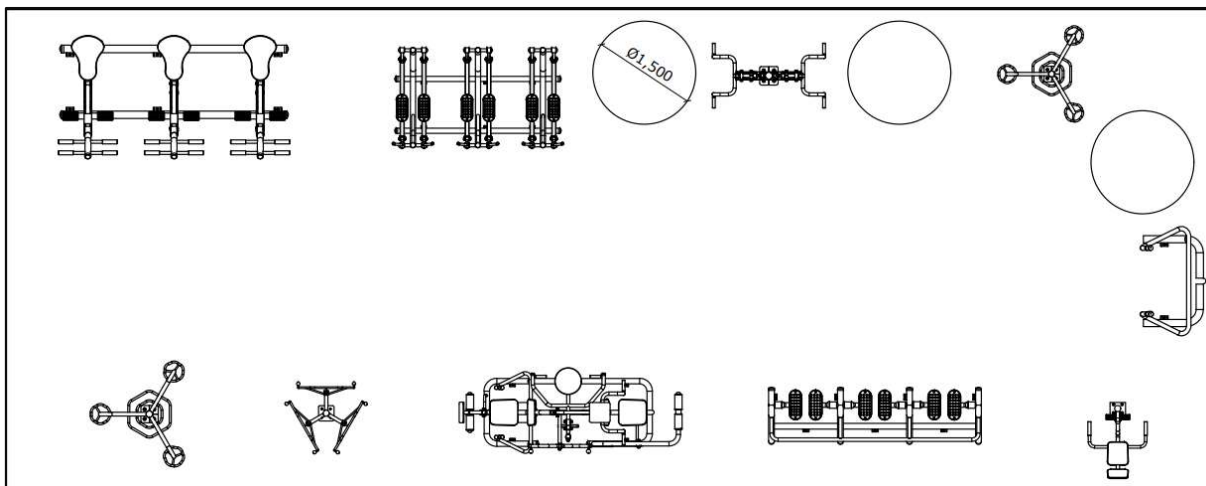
Projeto em planta baixa de academia de ginástica ao ar livre
